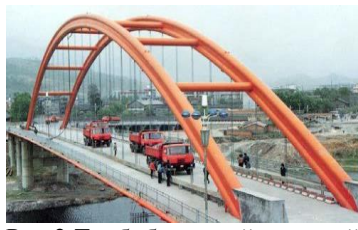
Трубобетонный арочный мост Wangchang East River Bridge.
